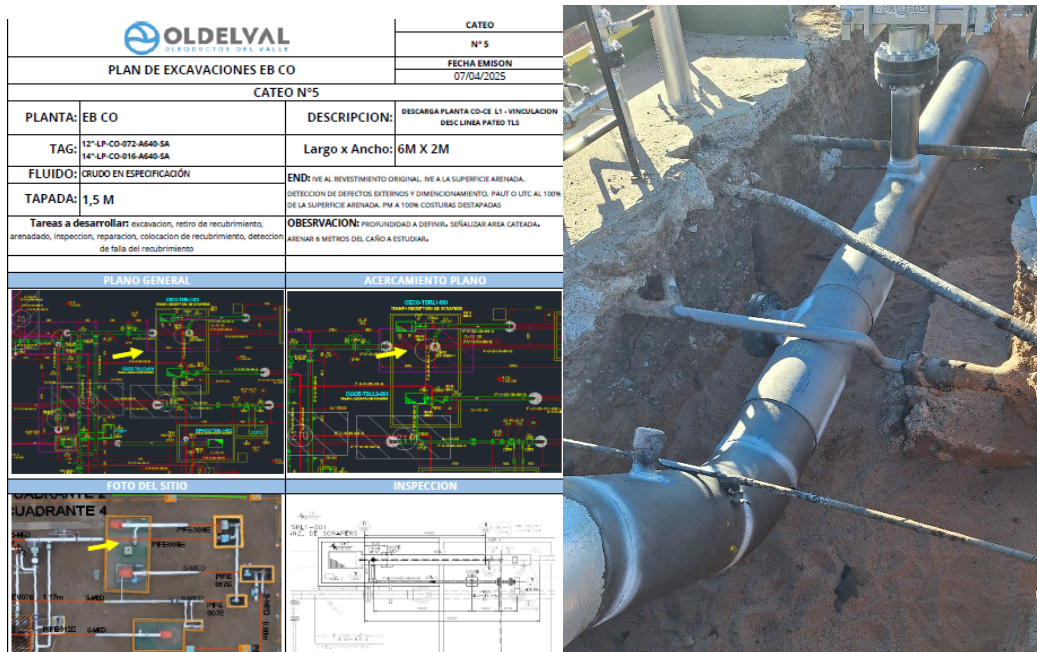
HOJA DE EXCAVACIÓN – SITIO DE EXCAVACIÓN
